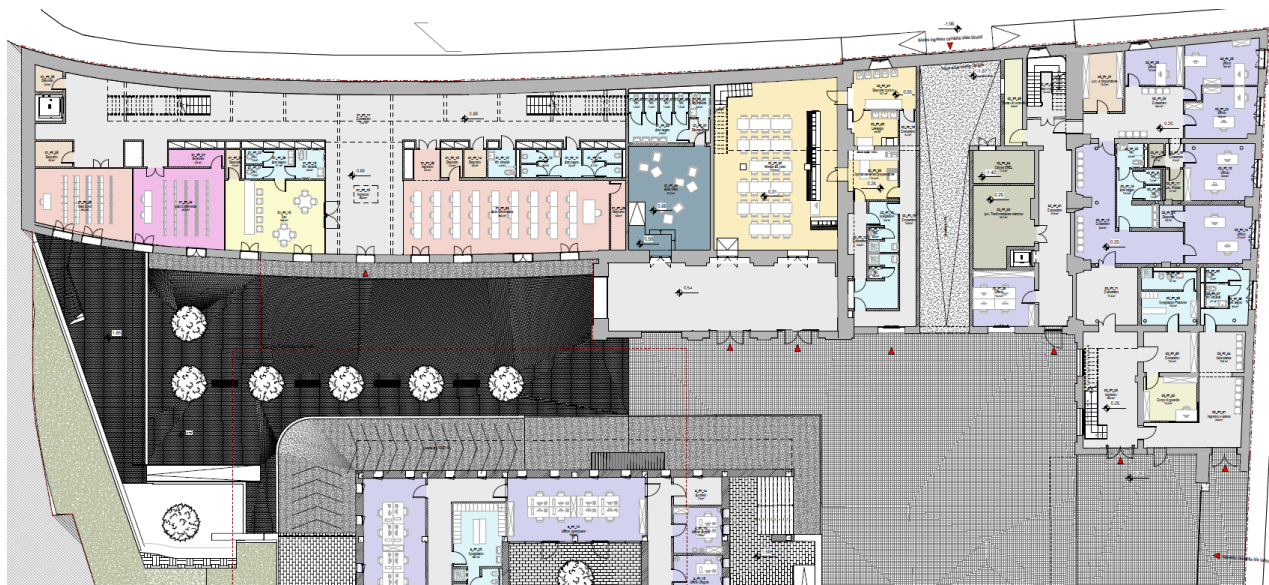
pianta piano terra – estratto della pianta con le indicazioni funzionali
